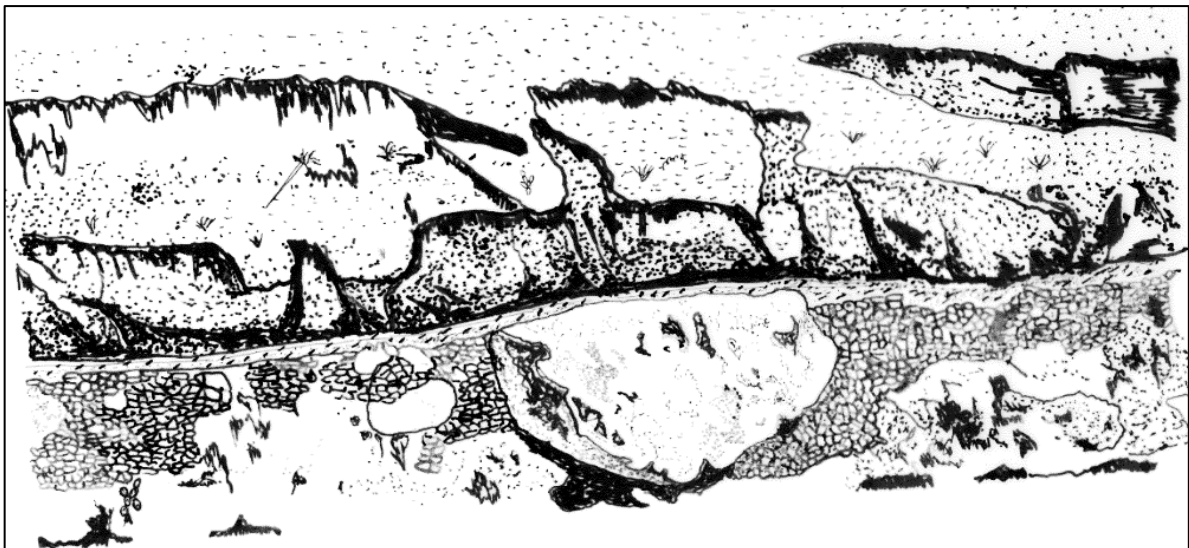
Croquis del camino con corte en roca madre y muro de contención.
